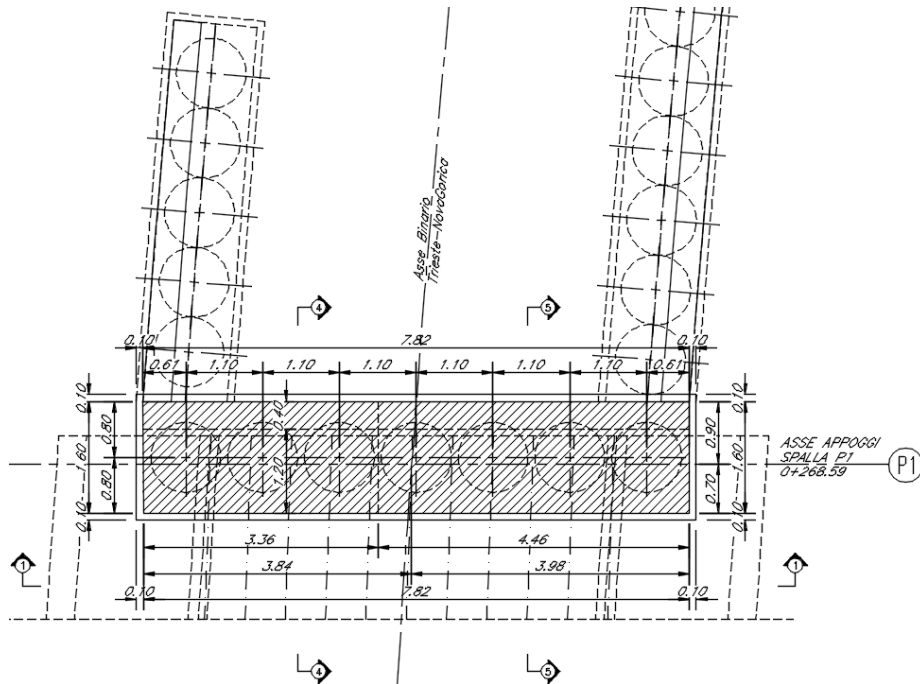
6: Spalla P1 - Sezione orizzontale 2-2 (sezione a quota fondazione)
